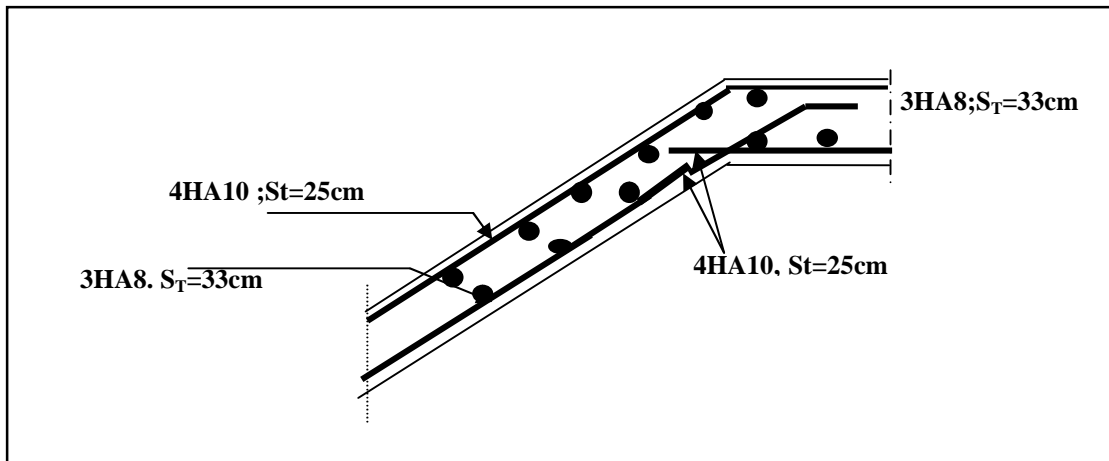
Schéma de ferrailage des volées I, II de l'escalier type II
